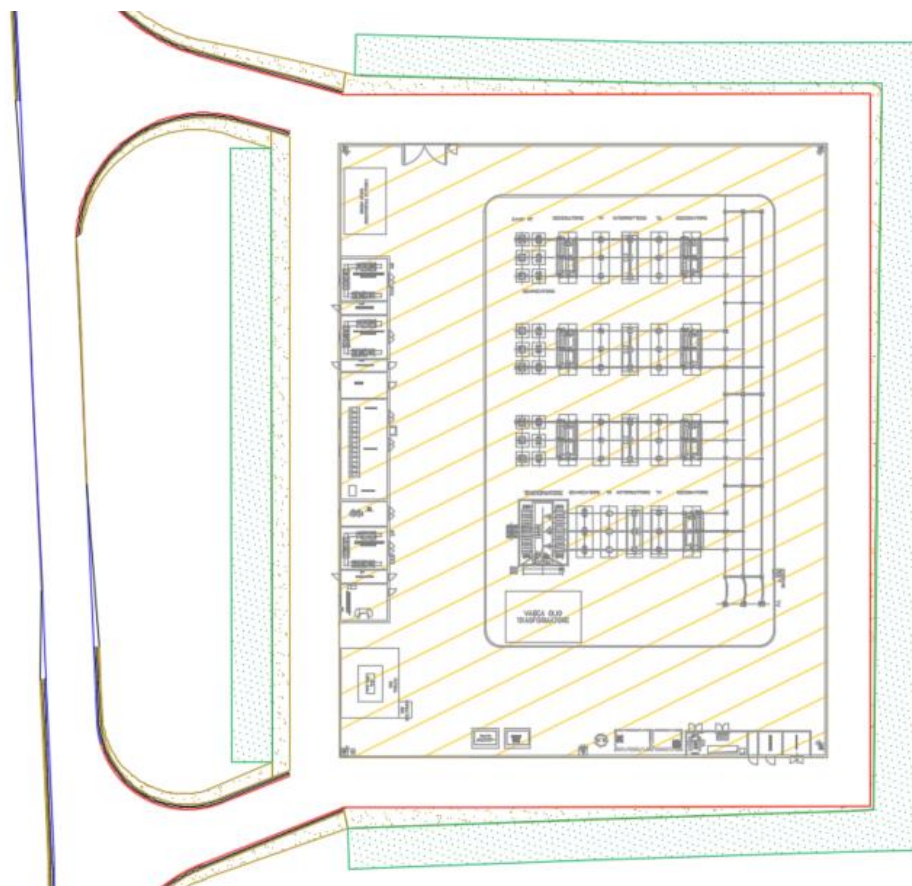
Planimetria Sottostazione multiutente 150/30 kV
